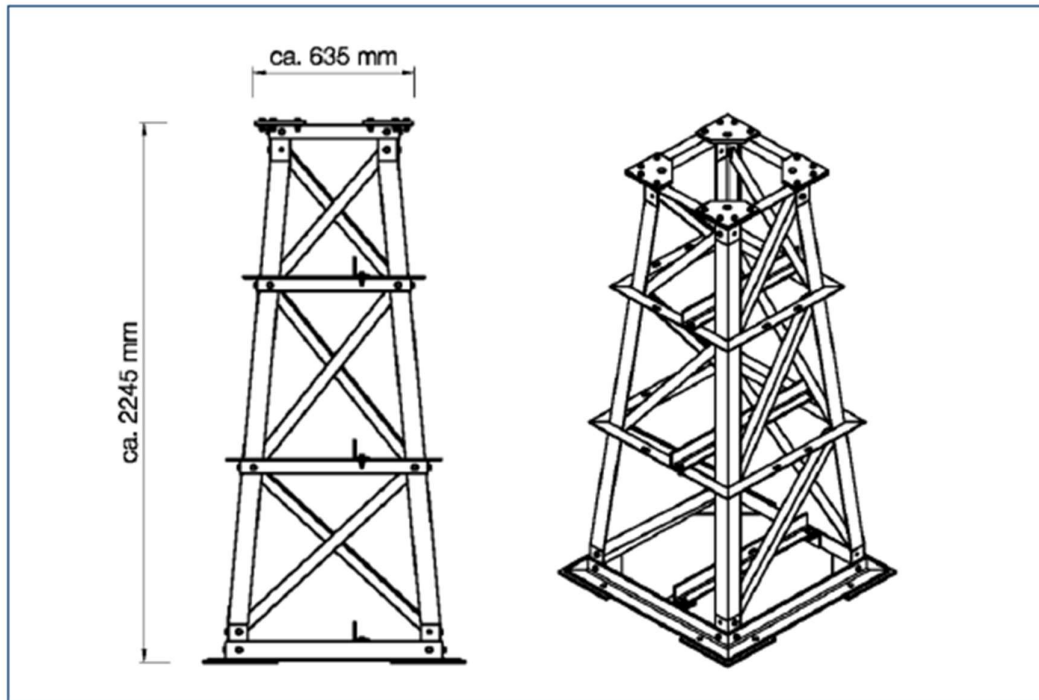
Traliccio porta terminale per installazione in stazione elettrica
